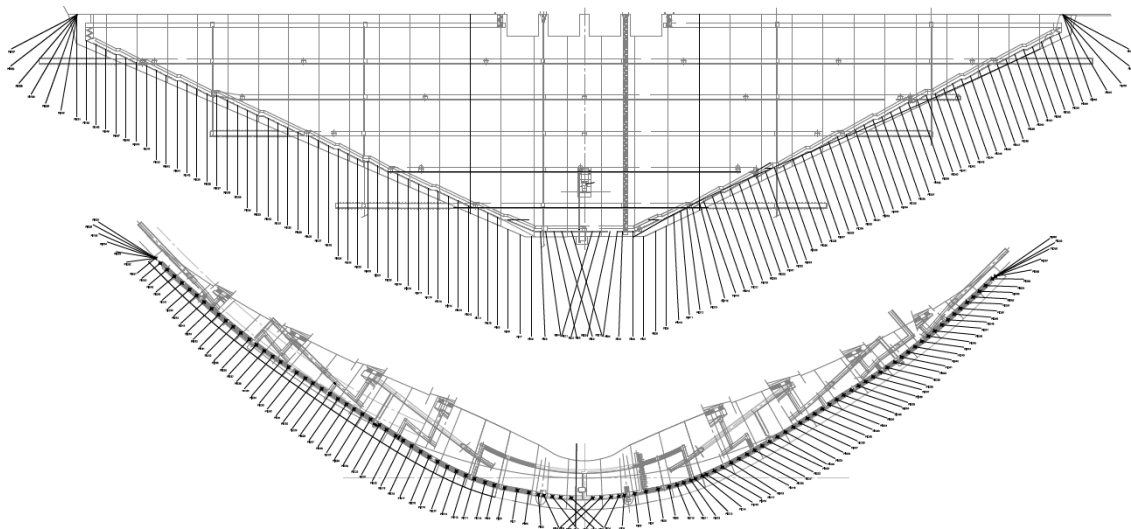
Representação da furação de impermeabilização em alçado e em planta respetivamente
